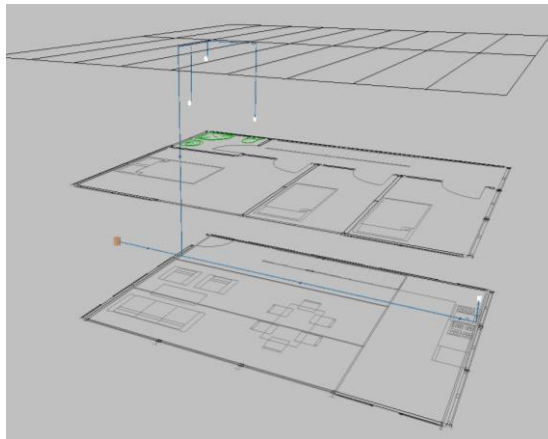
Conexión de fontanería planta baja y alta de la vivienda de 2 plantas, vista 3D
